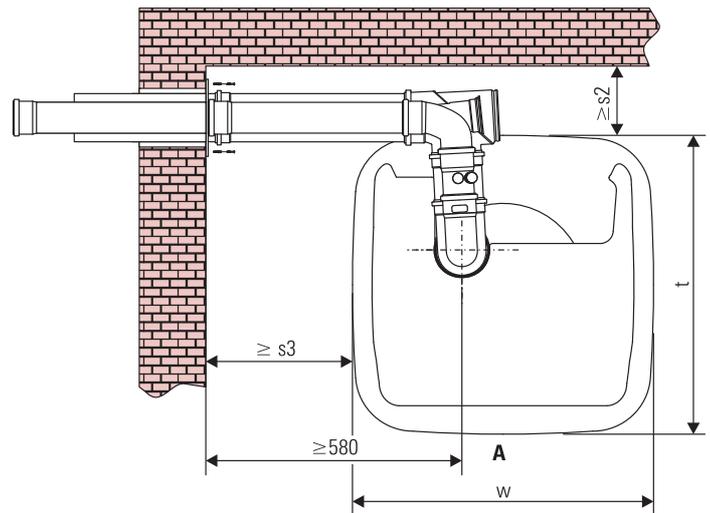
Vista dall'alto collegamento fumi GSU laterale con SET K (v. sezione 3.5.3)
